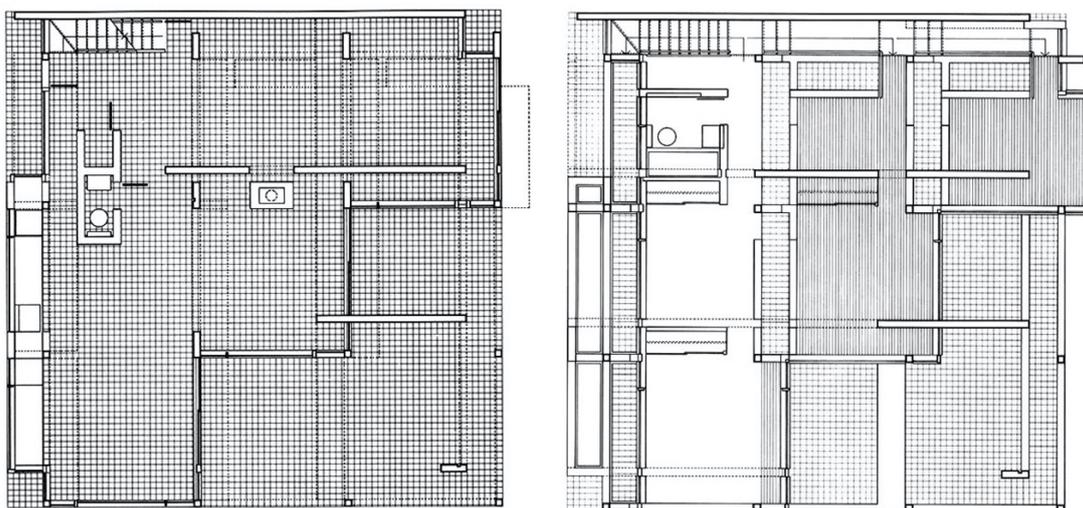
[À esquerda] Planta do pavimento térreo da *House II*. Fonte: <https://www.metalocus.es/en/news/house-ii-peter-eisenman-looking-a-new-owner>. Acessado em: 20 de junho de 2020. [À direita] Planta do pavimento superior da *House II*. Fonte: <https://www.metalocus.es/en/news/house-ii-peter-eisenman-looking-a-new-owner>. Acessado em: 20 de junho de 2020.
